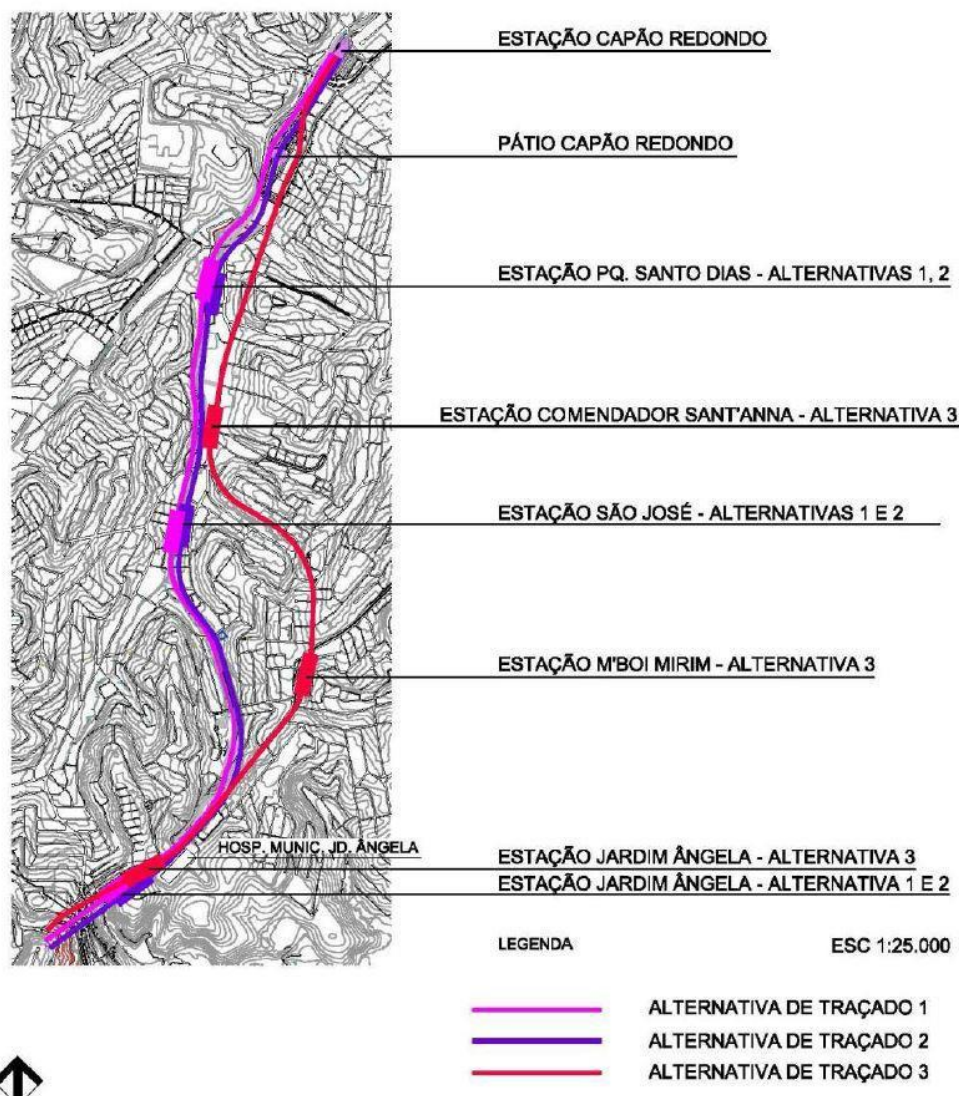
Planta Alternativas de traçado para a extensão Capão Redondo / Jardim Ângela da Linha 5-Lilás
